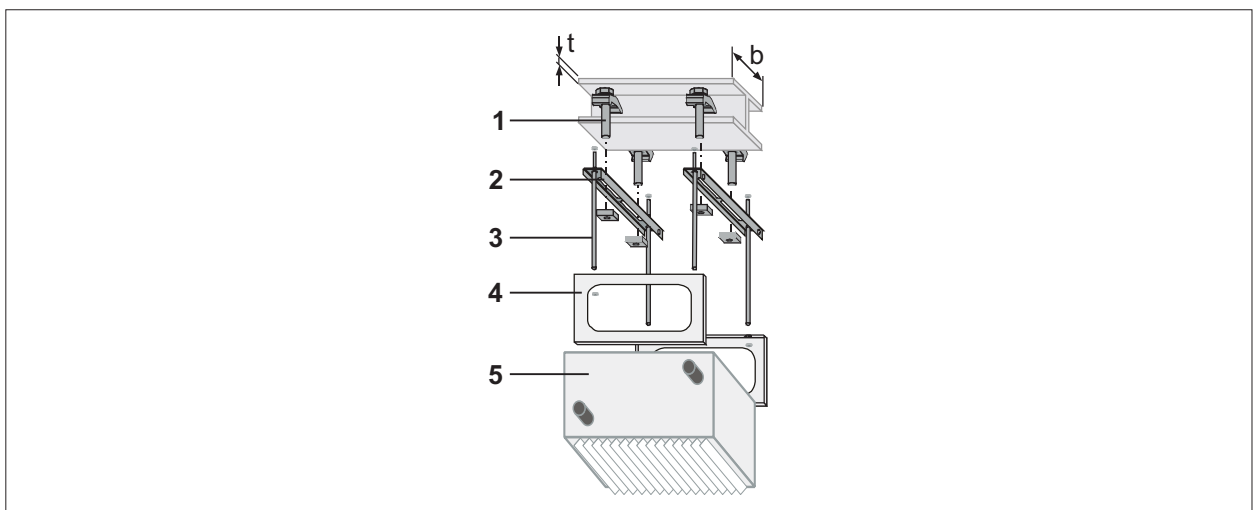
Монтаж воздухонагревателя к стальной балке с помощью подвески
